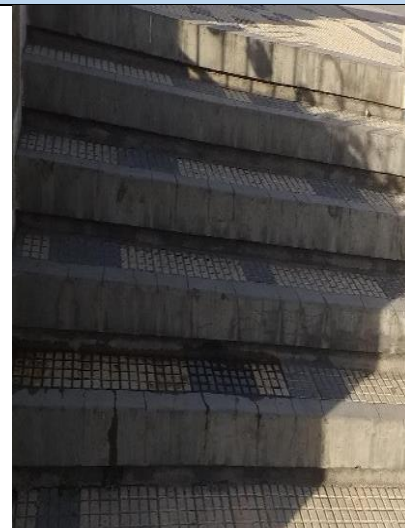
Escalera ubicada en la plaza de armas, afectada por grietas.
